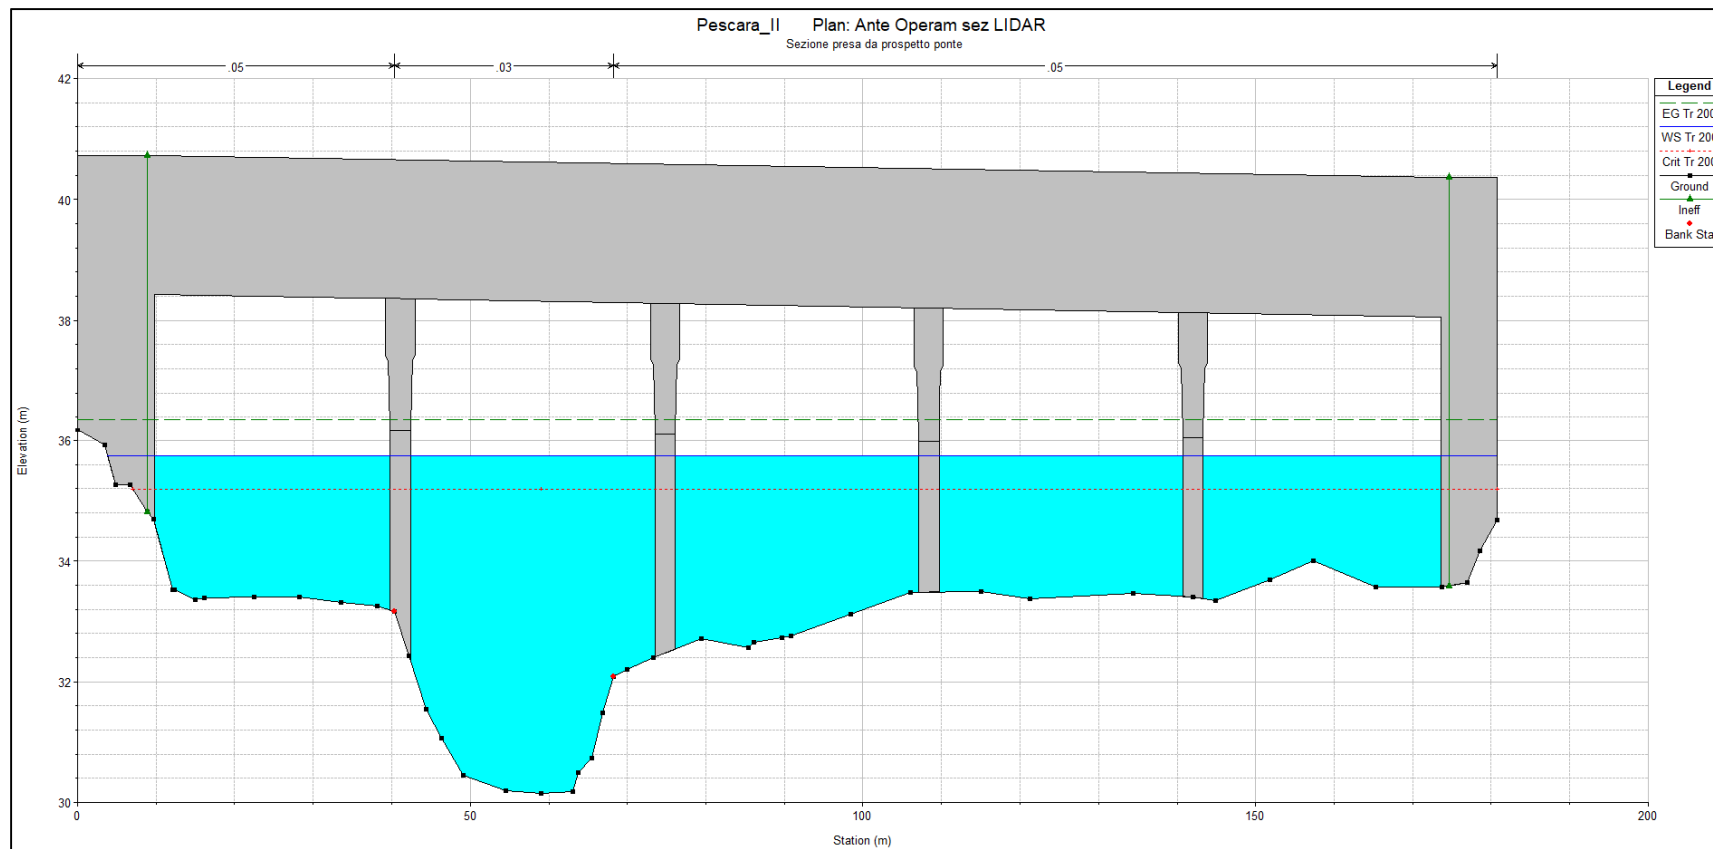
“Stato di Fatto Tr 200 anni, sezione 3.9 BR UP, prospetto Ponte delle Fascine”
